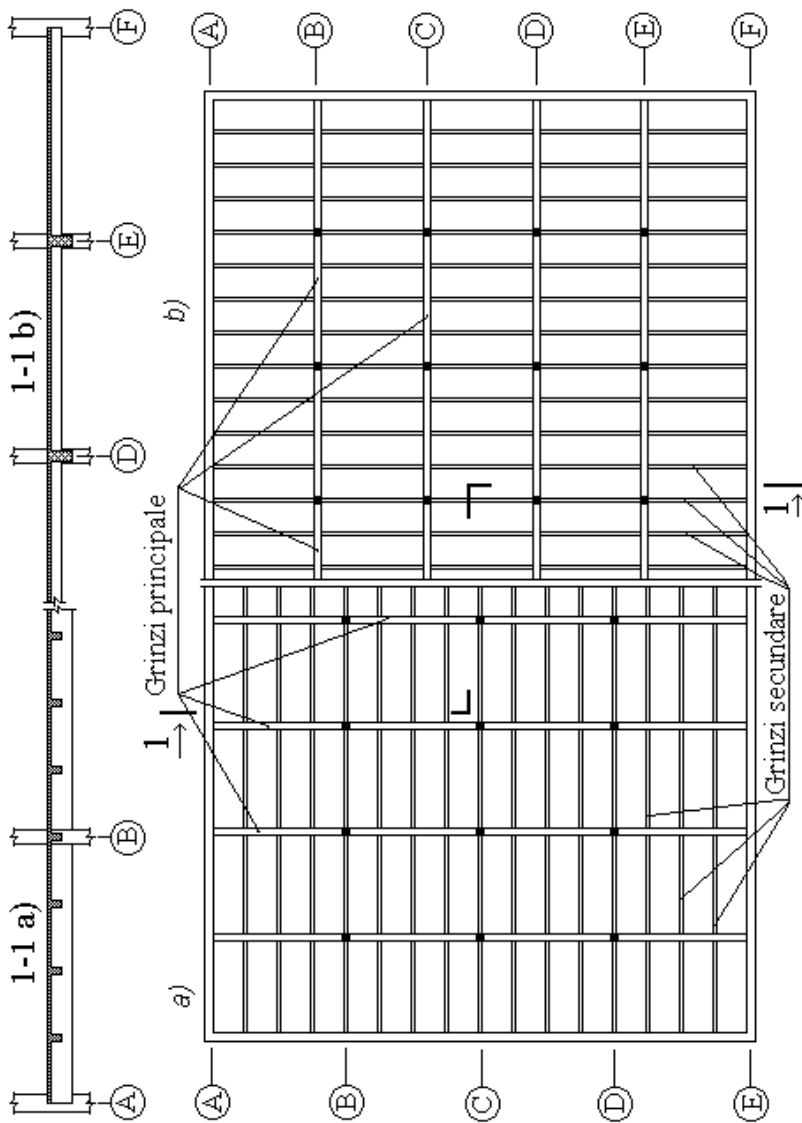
Schema constructivă a planșelor cu grinzi din beton armat monolit
